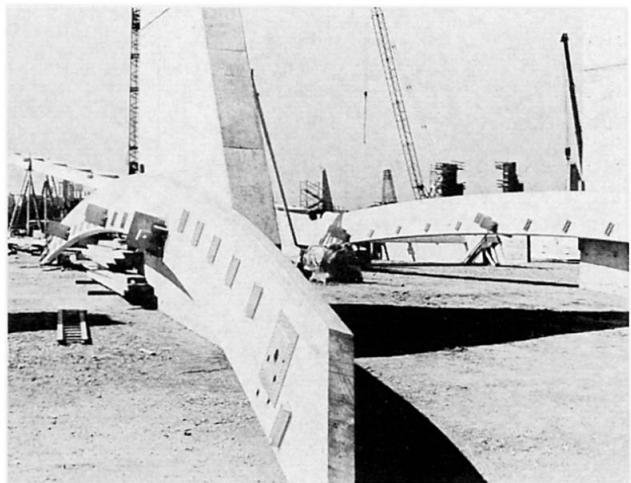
Mit den erforderlichen Anschluss- und Stoßverbindungen versehen, werden auf der Baustelle jeweils 3 Brettschichtelemente zu einer 102 m langen Hängerippe montiert
